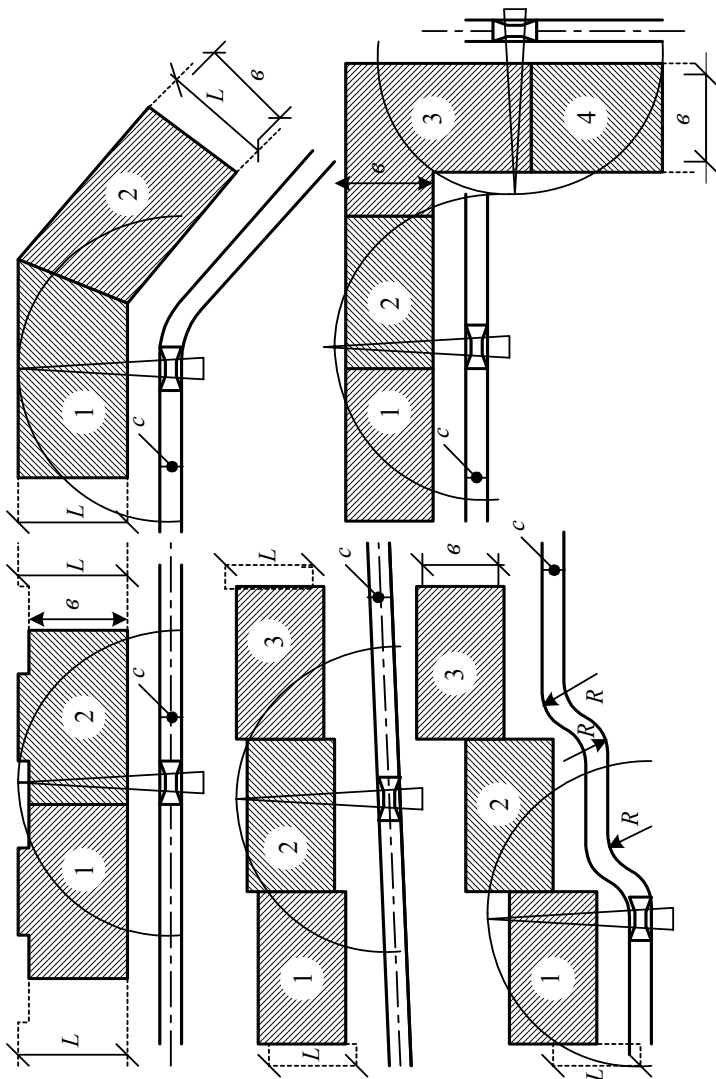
Схеми розстановки баштових кранів при монтажі конструкцій крупнопанельних будівель (1, 2, 3 – послідовність робіт по захваткам)
